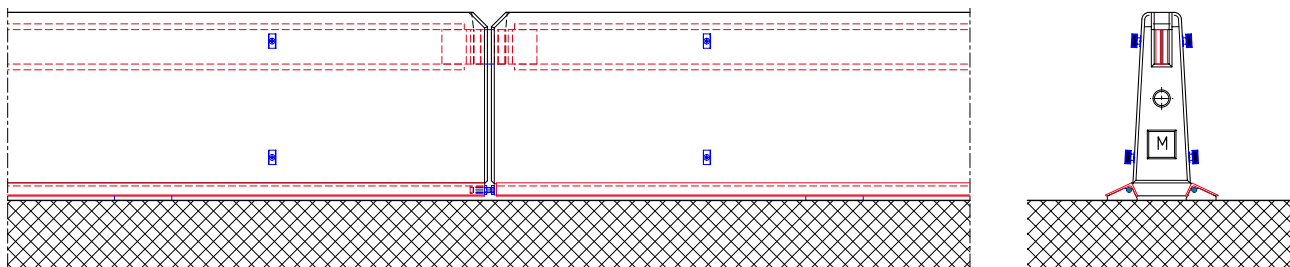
| Systemöversikt. Utdrag ur installationsritningen K706600.
